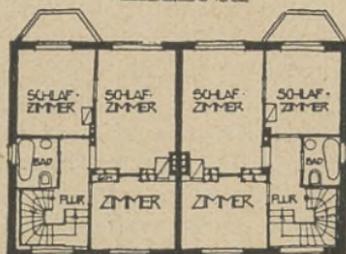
Kleines Doppelhaus mit Küche im Untergeschoß
